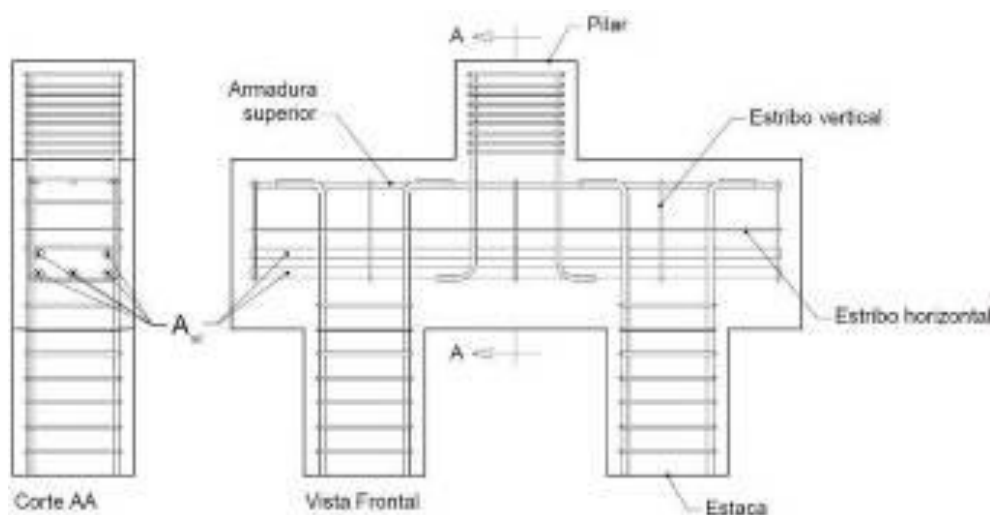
Detalhe esquemático das armaduras dos modelos 1 e 3 com armadura secundária
